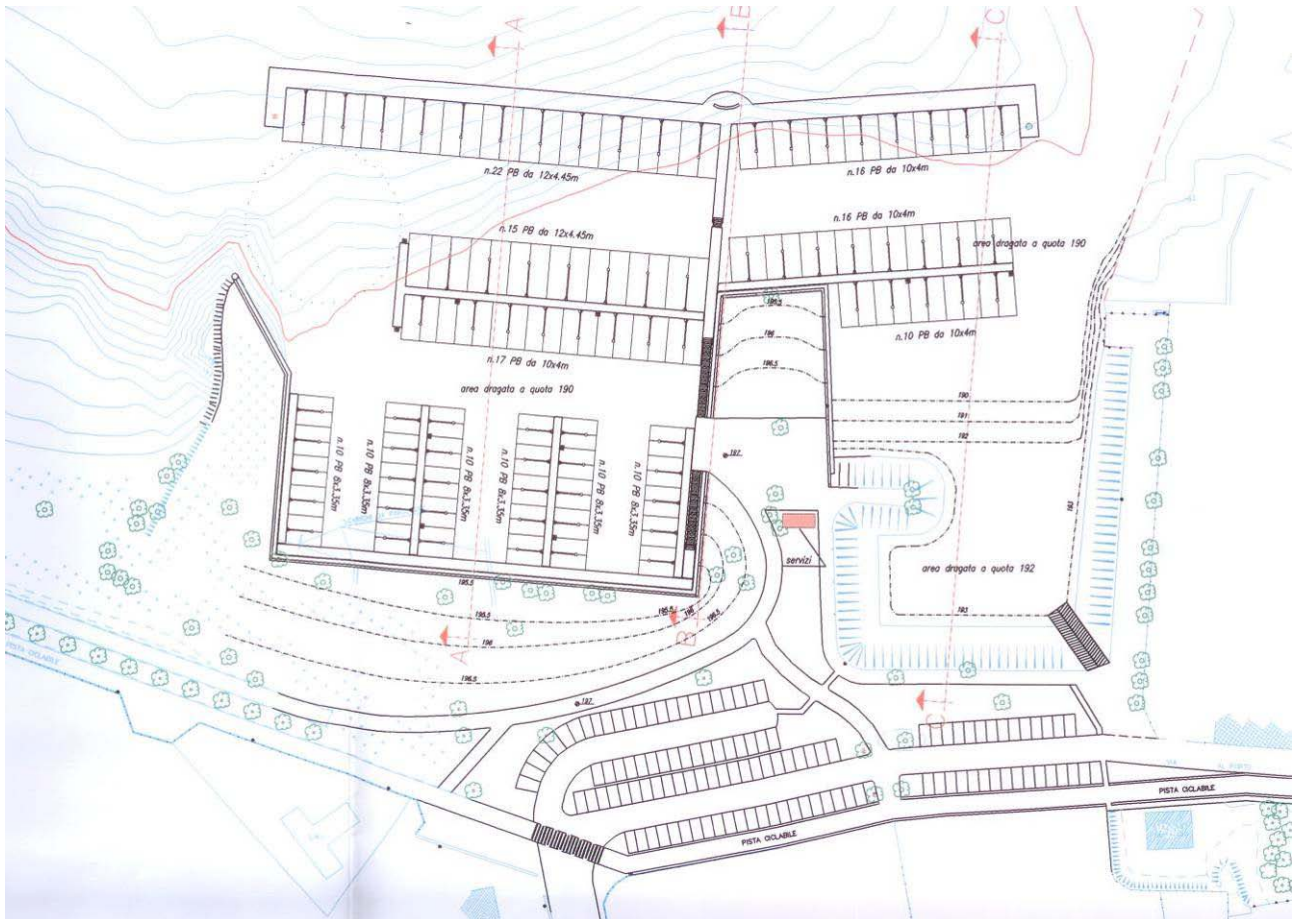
Planimetria della proposta del '98: si nota come la struttura del porto si inserisca, modificandola profondamente, nell'andamento della sponda
